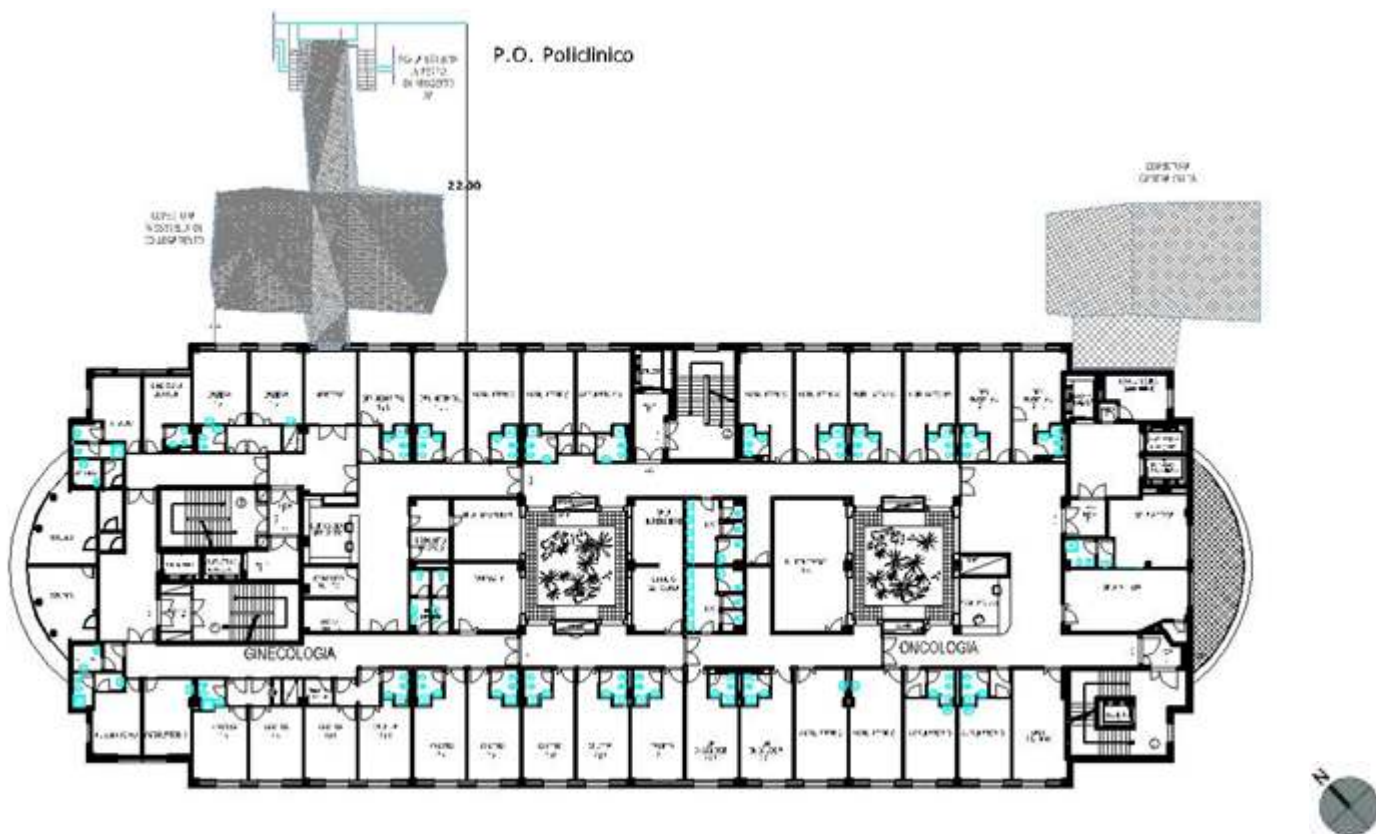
Planimetria Piano Quarto - livello +14,00.
